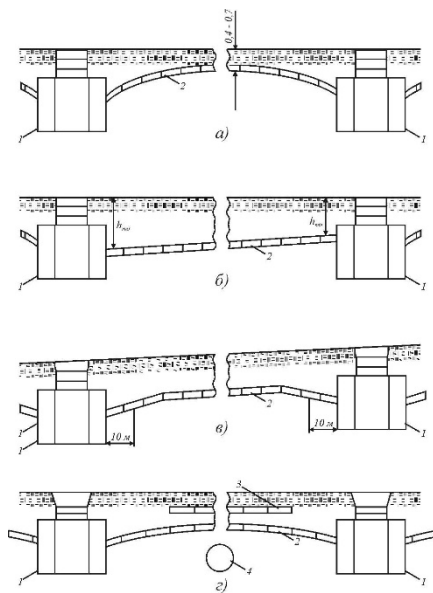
Профили прокладки трубопроводов кабельной канализации:
